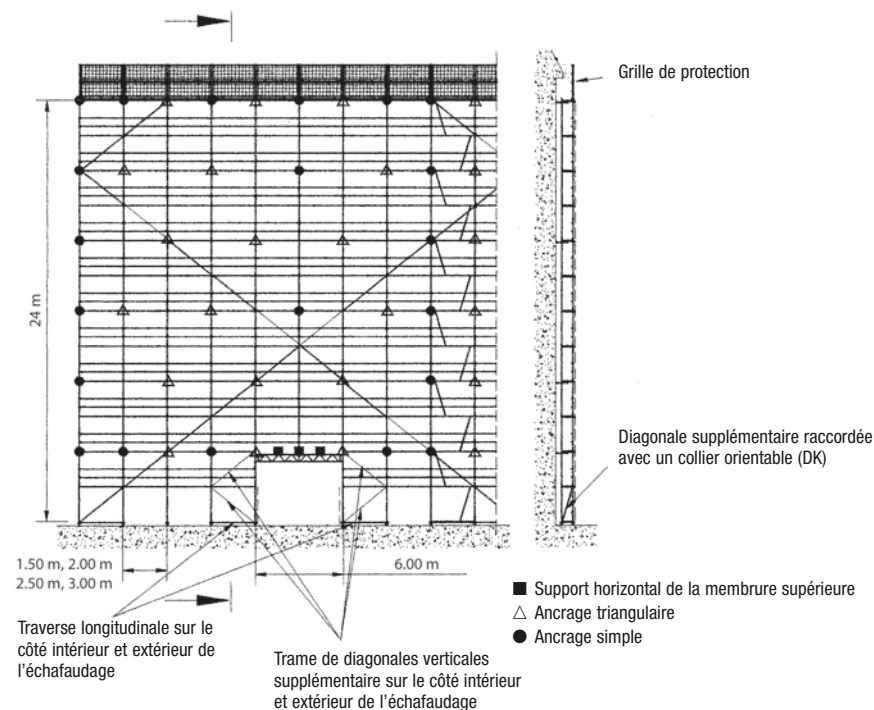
Poutre l = 6,00 m montée (sans entretoise, échafaudage sans revêtement)
